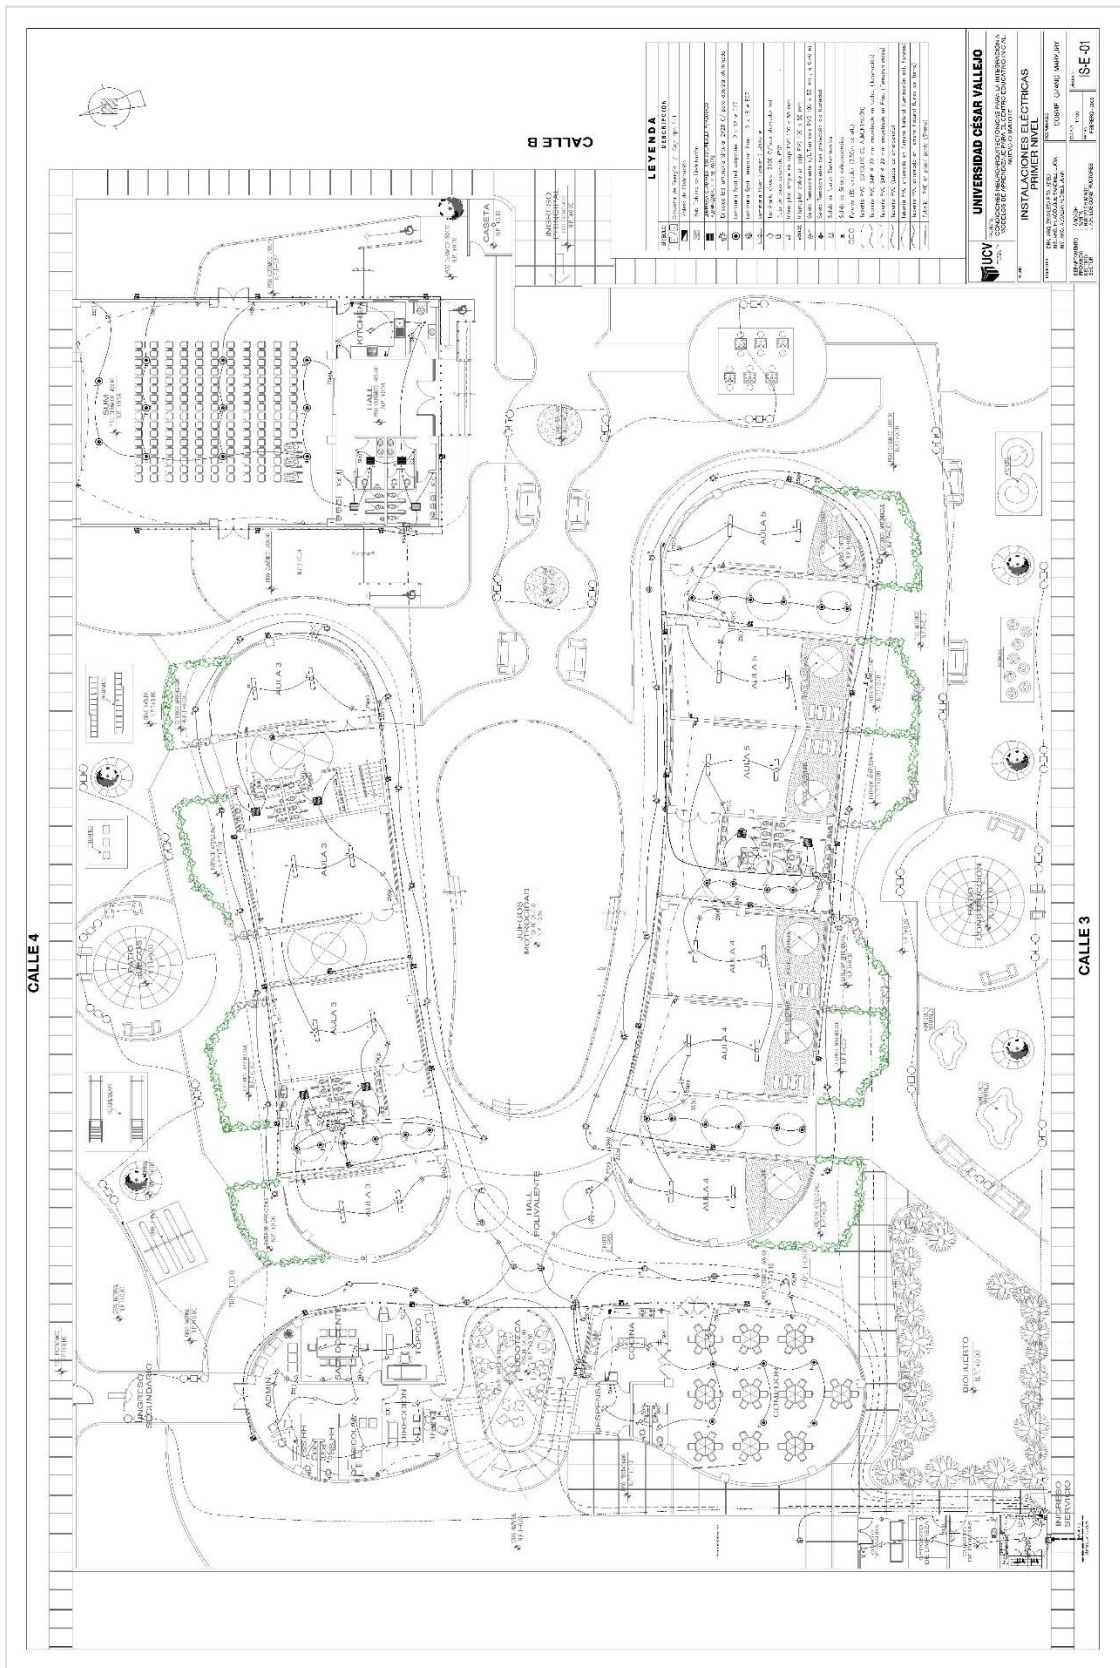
Plano de Instalaciones Eléctricas Primer Nivel.
